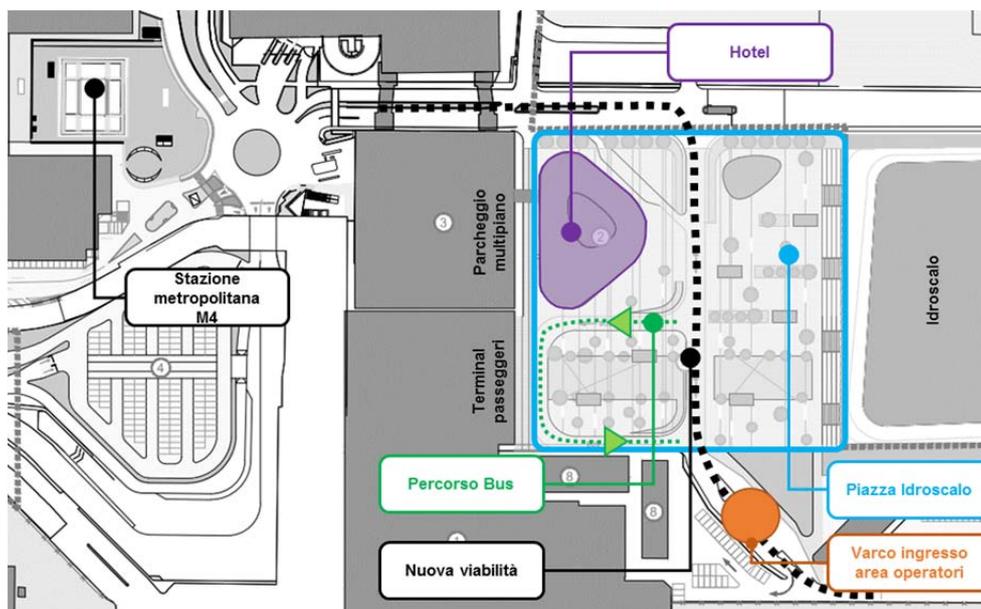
Strutture landside est: hotel e piazza idroscalo, configurazione prevista dal Masterplan
